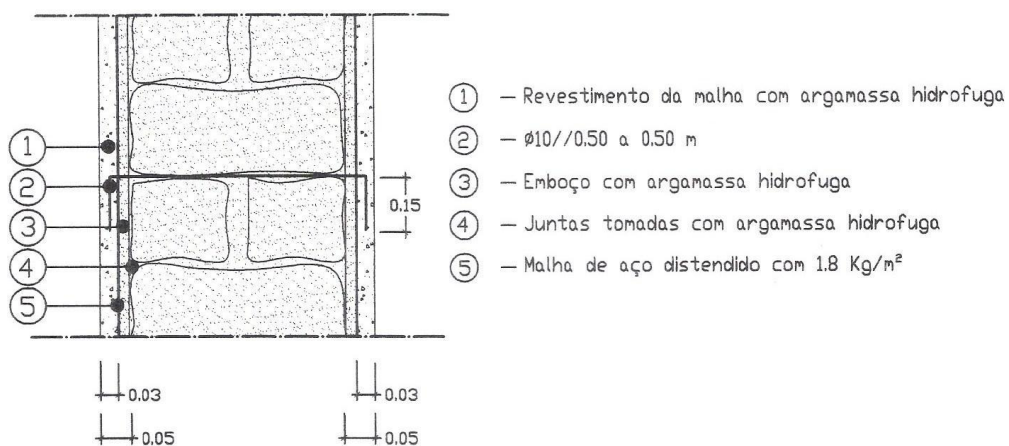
14 Reboco armado nas duas faces da parede, [37].
